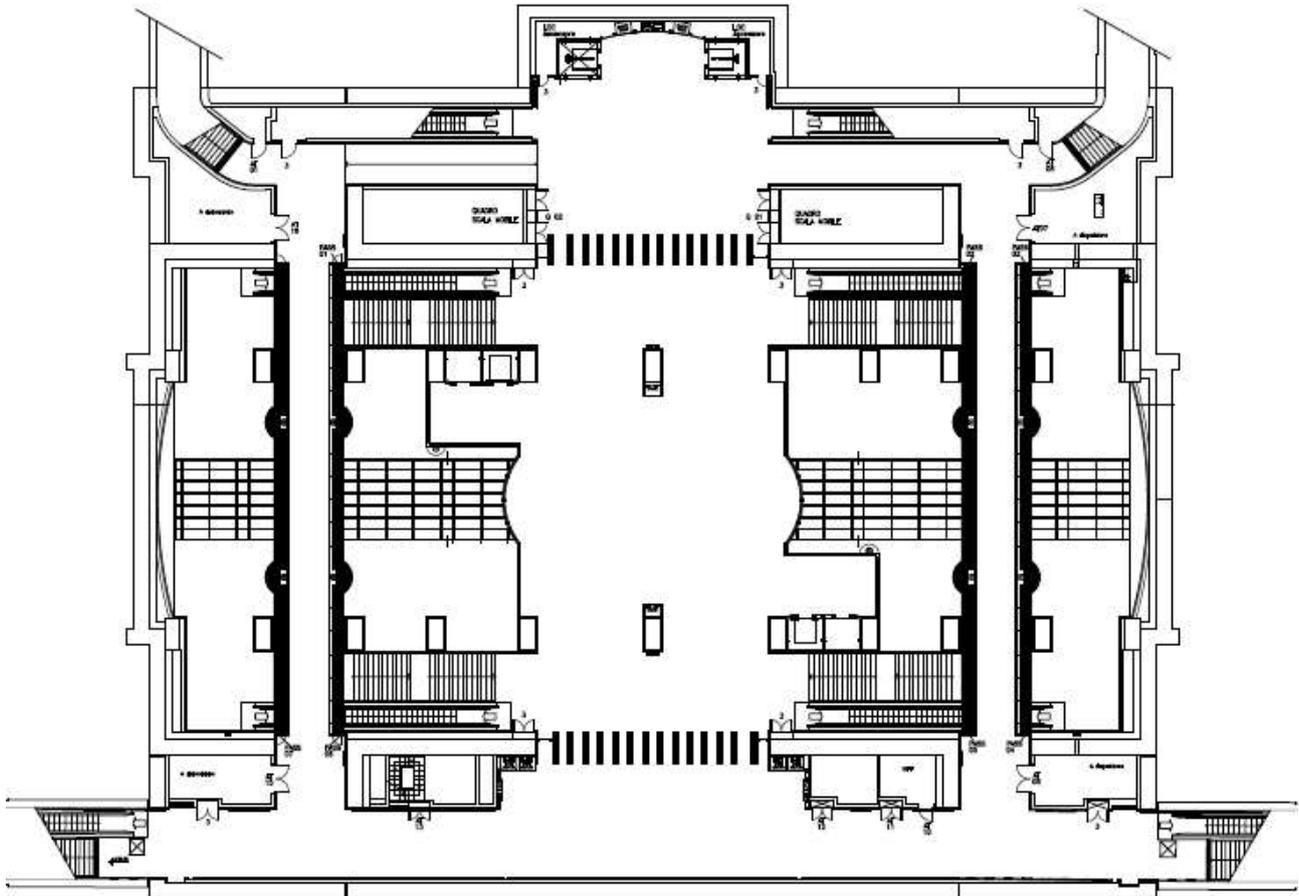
Pianta aerea atrio stazione metropolitana Porta Nuova
